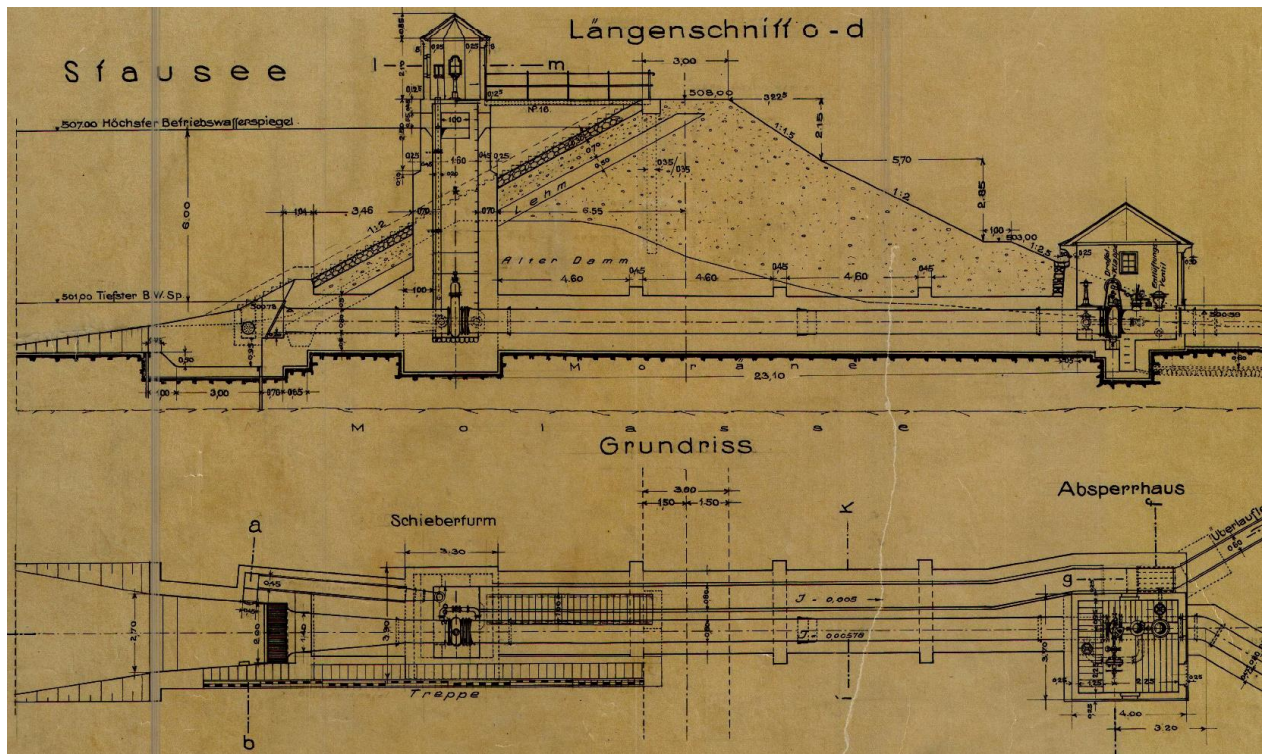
Längsschnitt und Grundriss Entnahmebauwerk, Plan aus dem Jahr 1924 [14]
